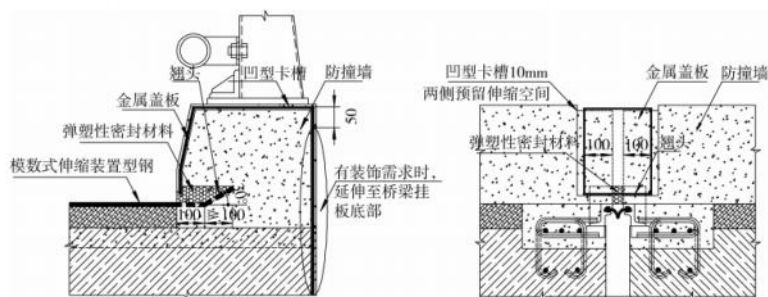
伸缩缝端头断面布置示意图(单位:mm)
